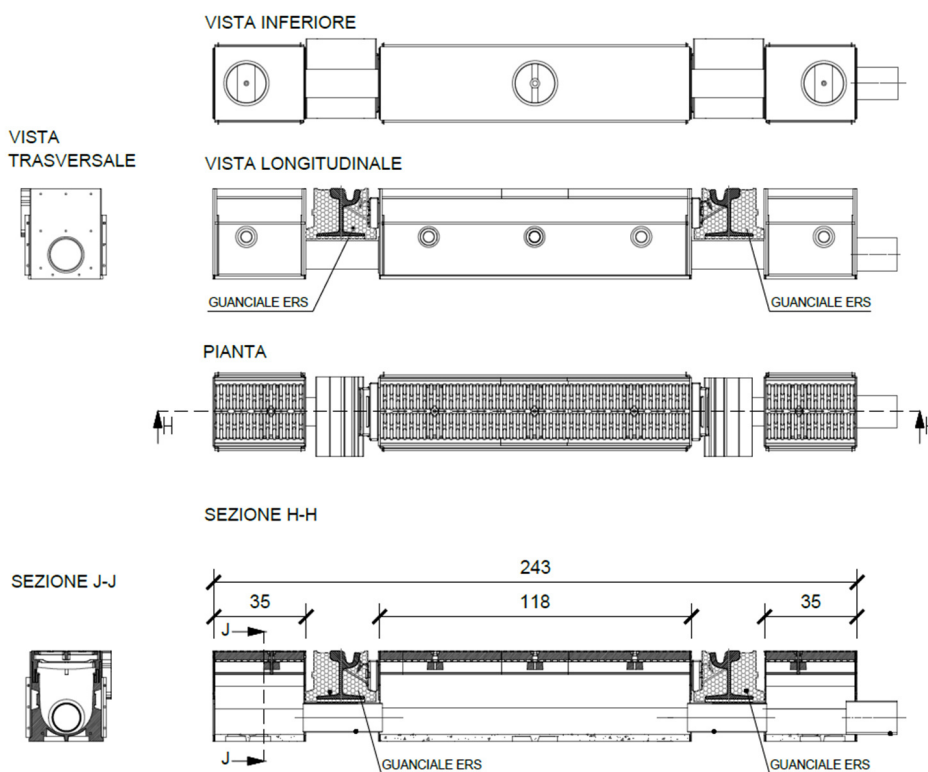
CANALETTA DRENAGGIO SEDE
